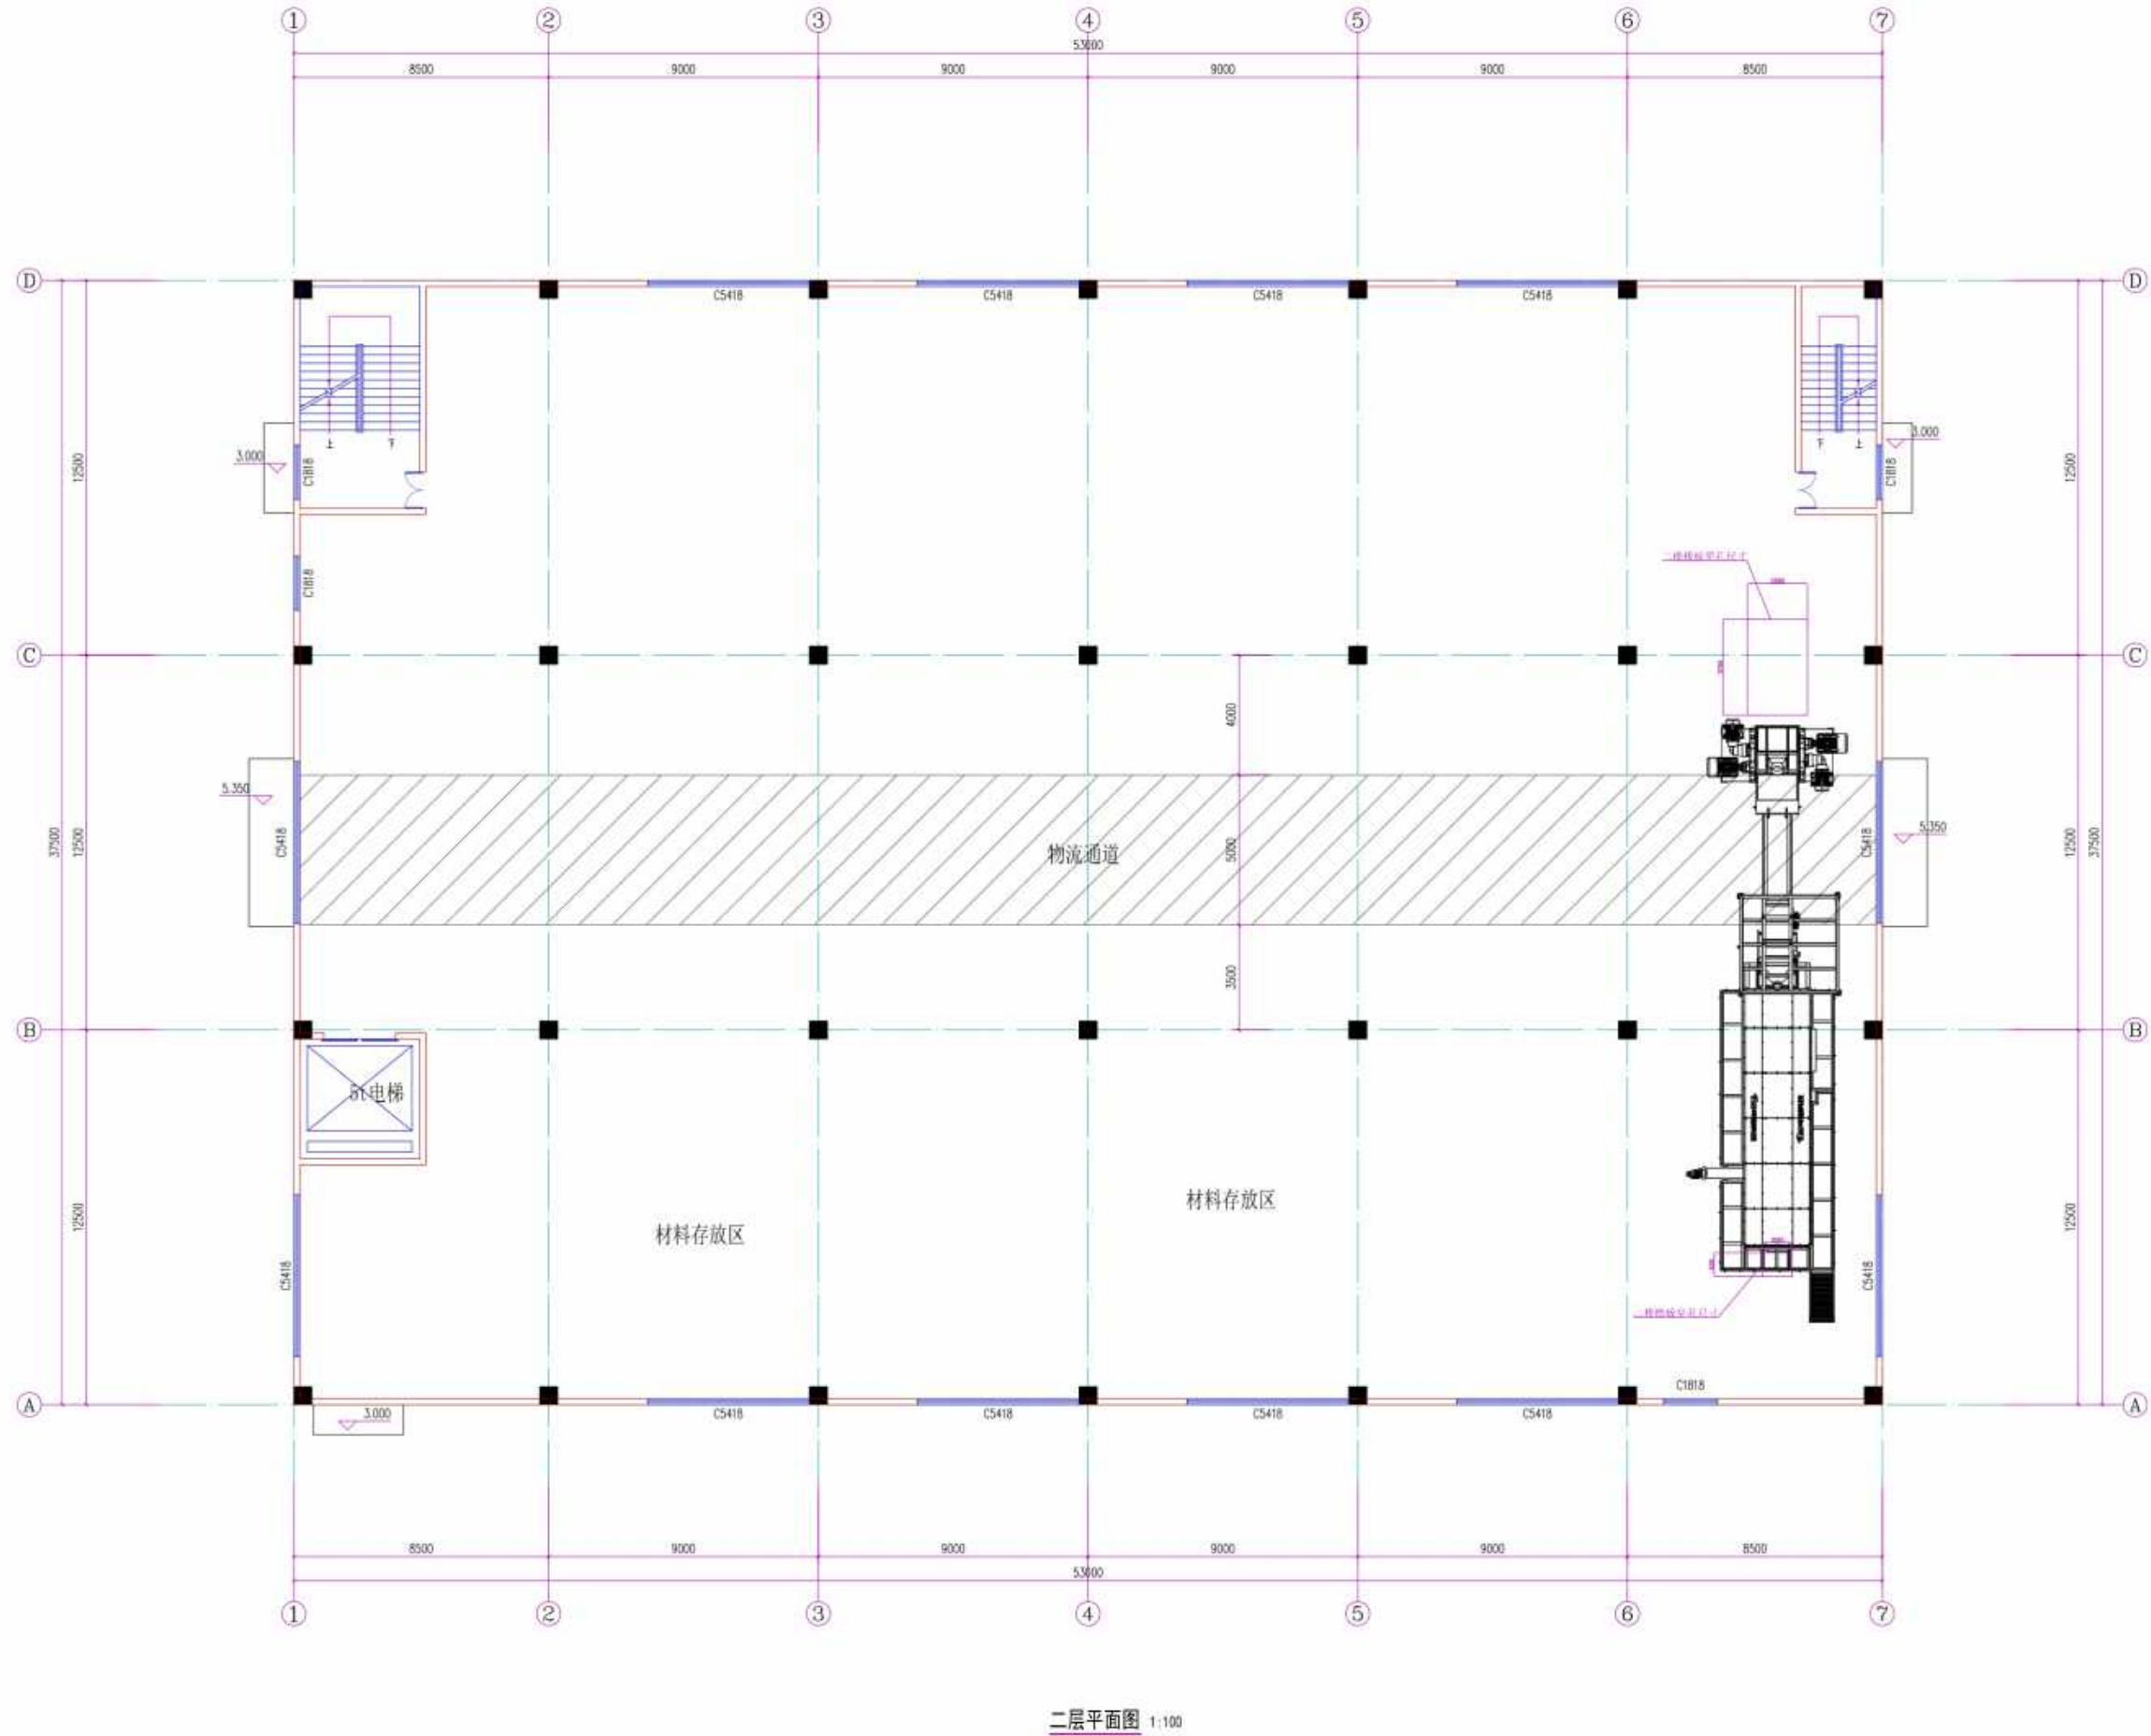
原技改扩建项目废包装桶车间二层平面布置图
